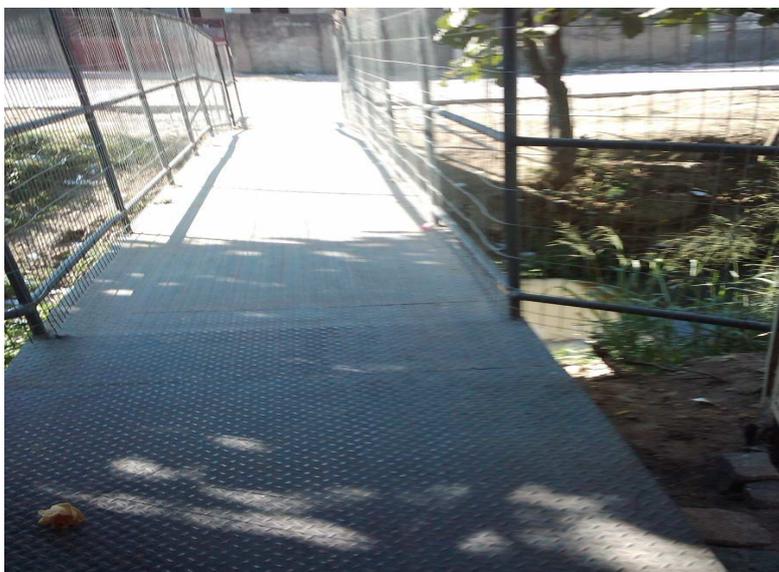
Ponte que liga a rua a entrada principal da E.M. Afonso Salles
